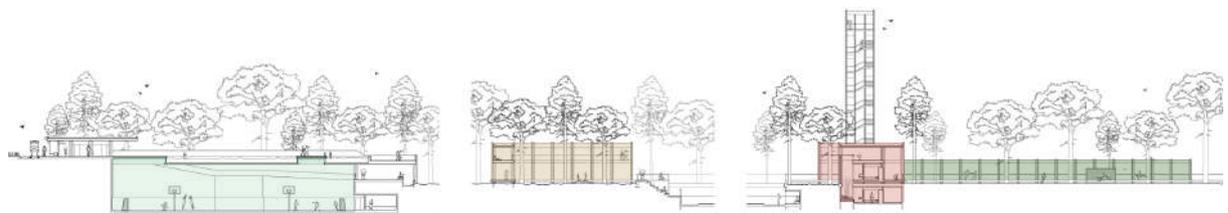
Corte transversal (A) da componente prática deste trabalho, correspondência à planta da figura 43.
